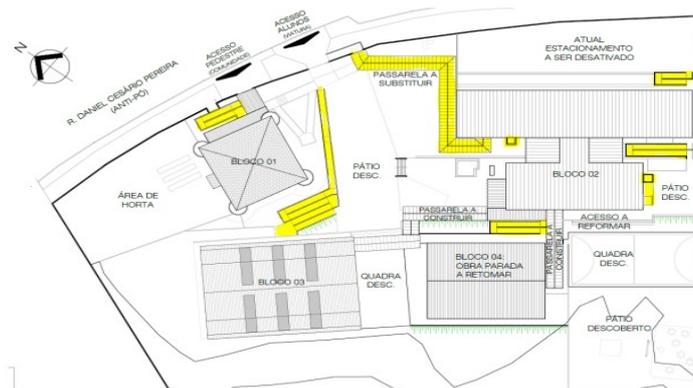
Recorte da planta de cobertura do Colégio com destaque para novas intervenções de acessibilidade: rampas e plataformas elevatórias a serem construídas.
